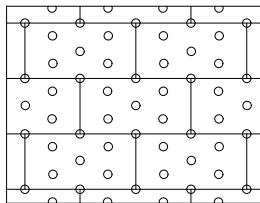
SCHÉMA ROZMÍSTĚNÍ HMOŽDINEK
